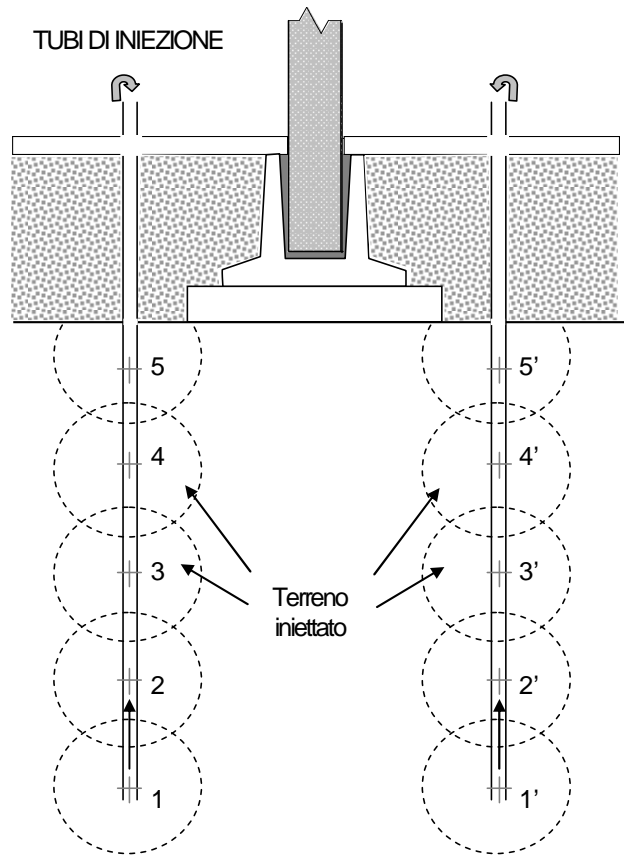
Iniezioni verticali in prossimità delle fondazioni.
